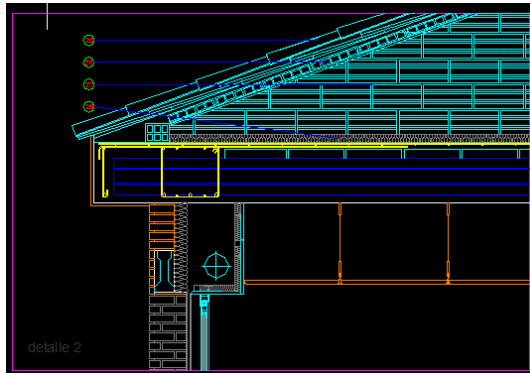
Obtenida del plano de detalles constructivos del proyecto.
